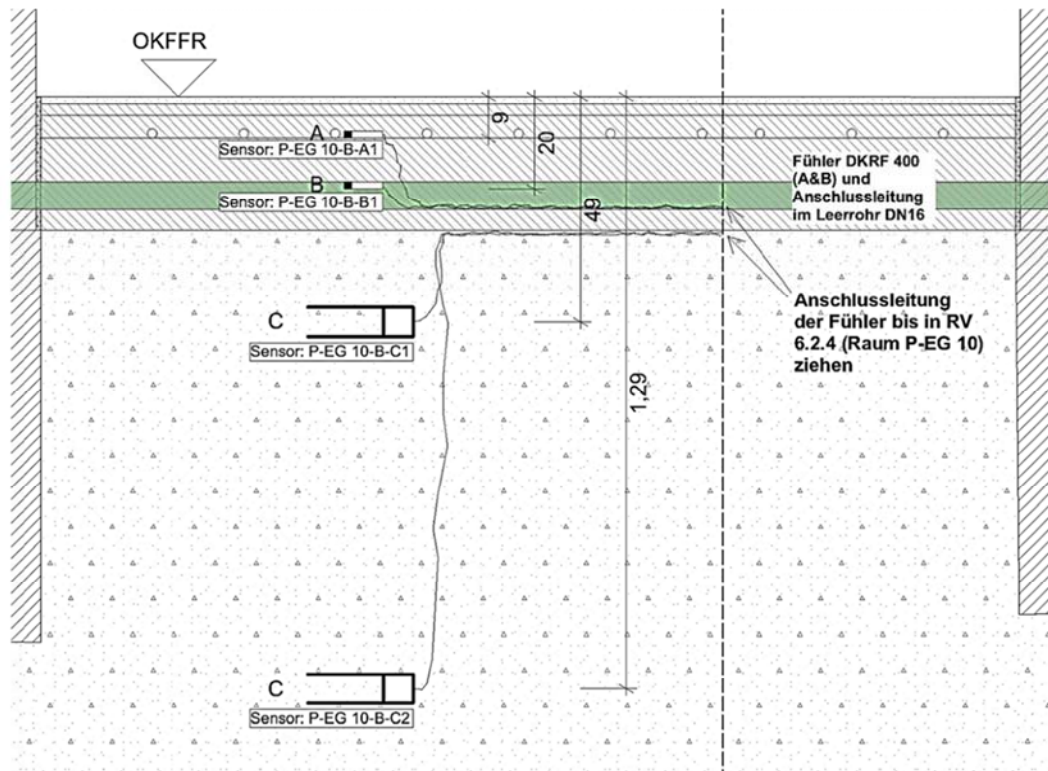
Schnitt durch den Fußbodenaufbau Drainage-Estrich mit den verorteten Klimamesspunkten
